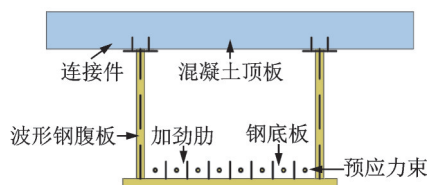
波形腹板钢箱-混凝土组合梁桥截面图
